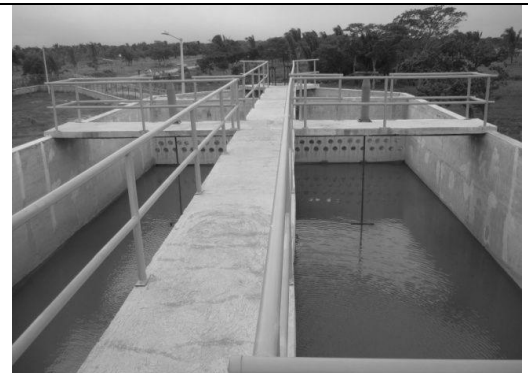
Imagen de la planta de tratamiento del Corregimiento de La Loma
